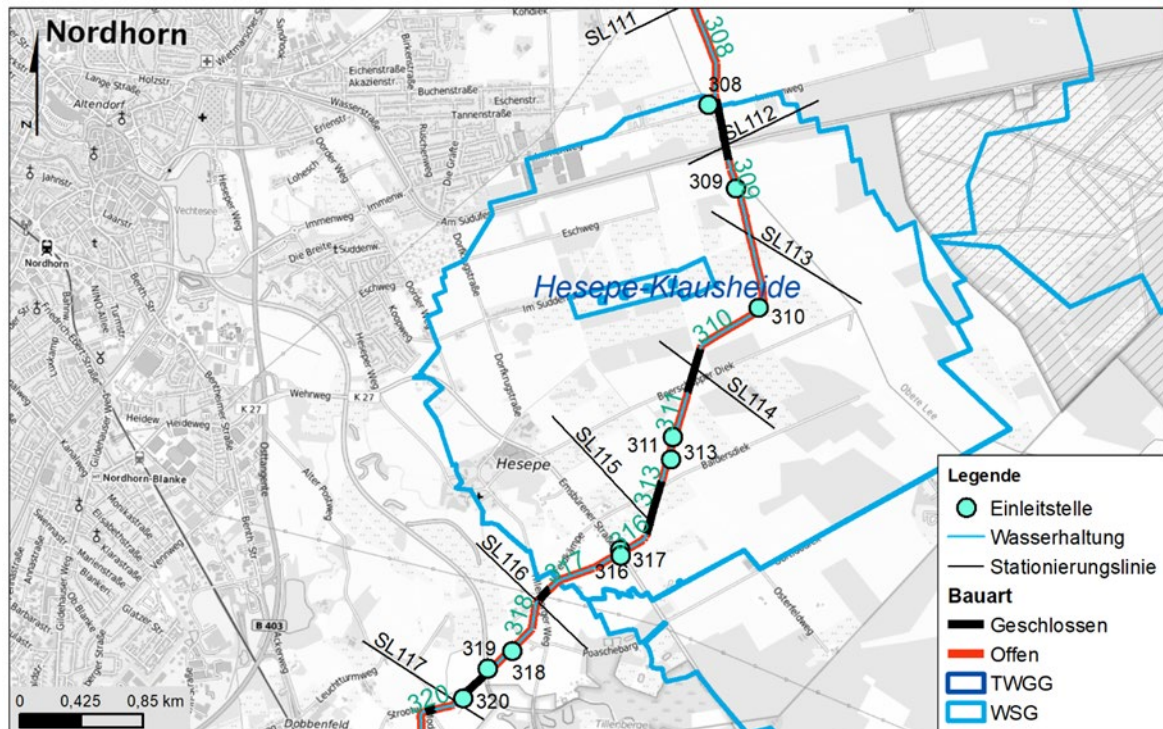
Lageplanausschnitt zum Trassenverlauf im WSG Hesepe-Klausheide Zone IIIA - (Gesamtdarstellung)
